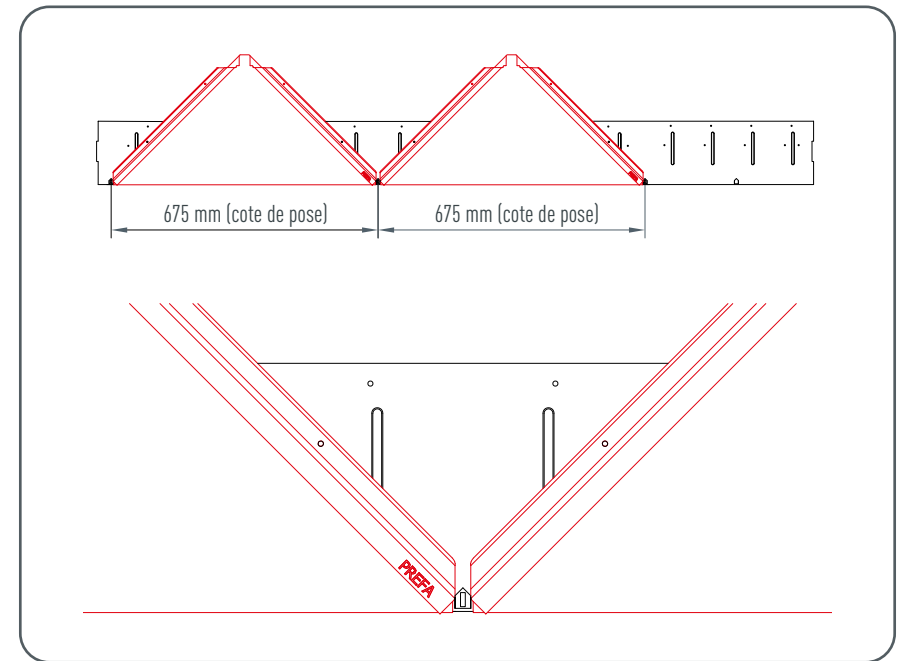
• Losanges de toiture 44 × 44 – Traçage
